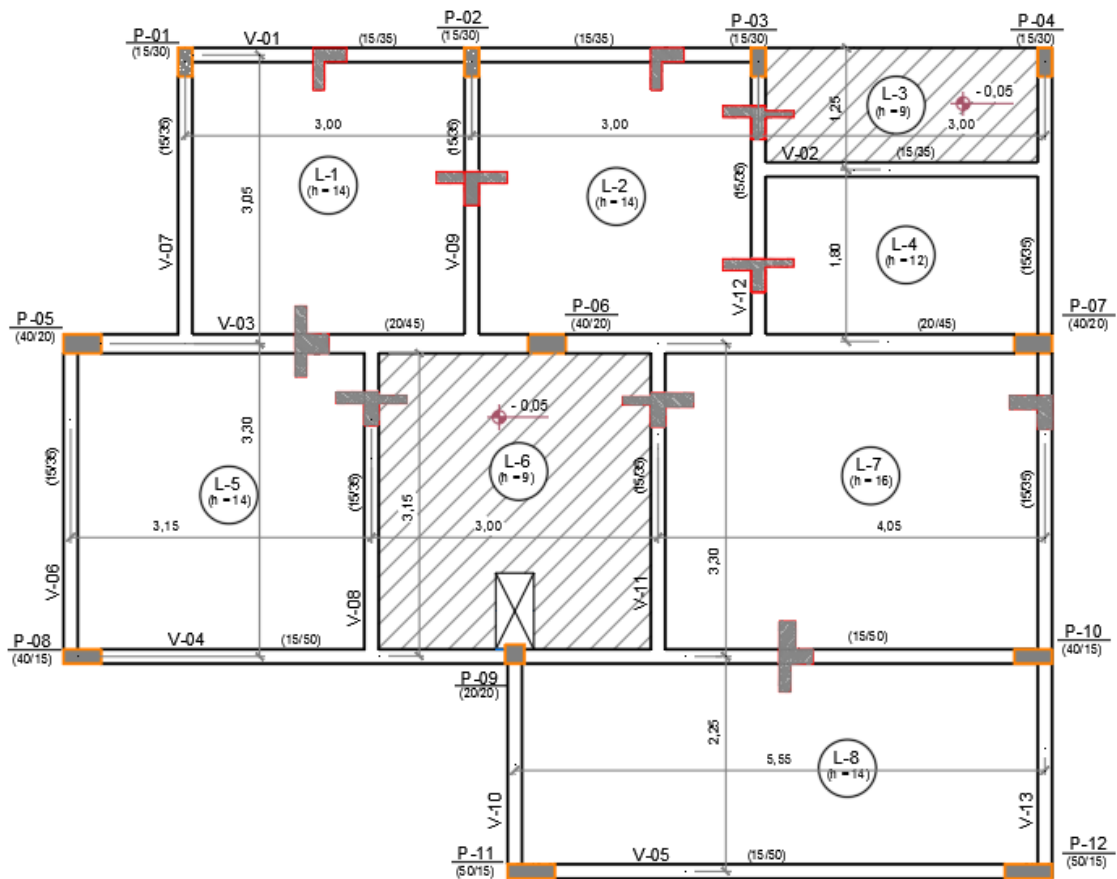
Planta de Fôrma - Pavimento Tipo.
